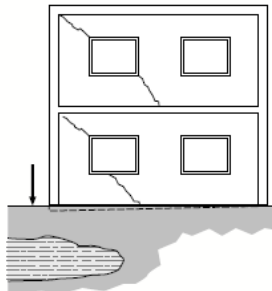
Fissuras diagonais: tipos e causas prováveis
